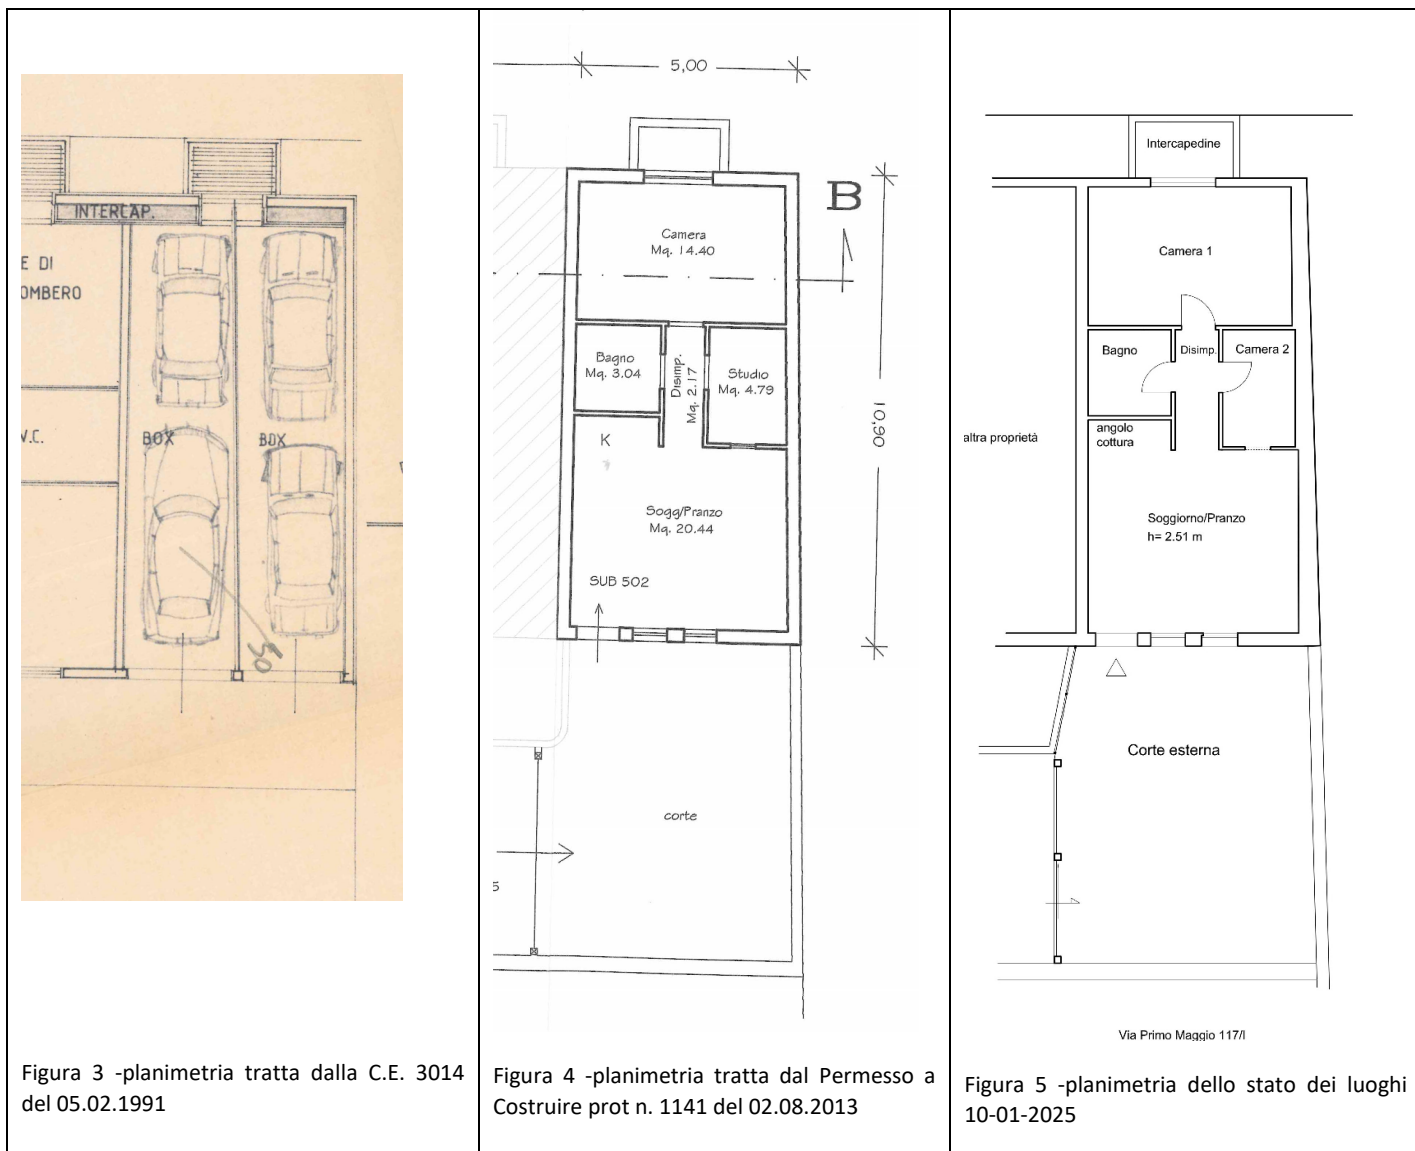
planimetria tratta dalla C.E. 3014 del 05.02.1991
